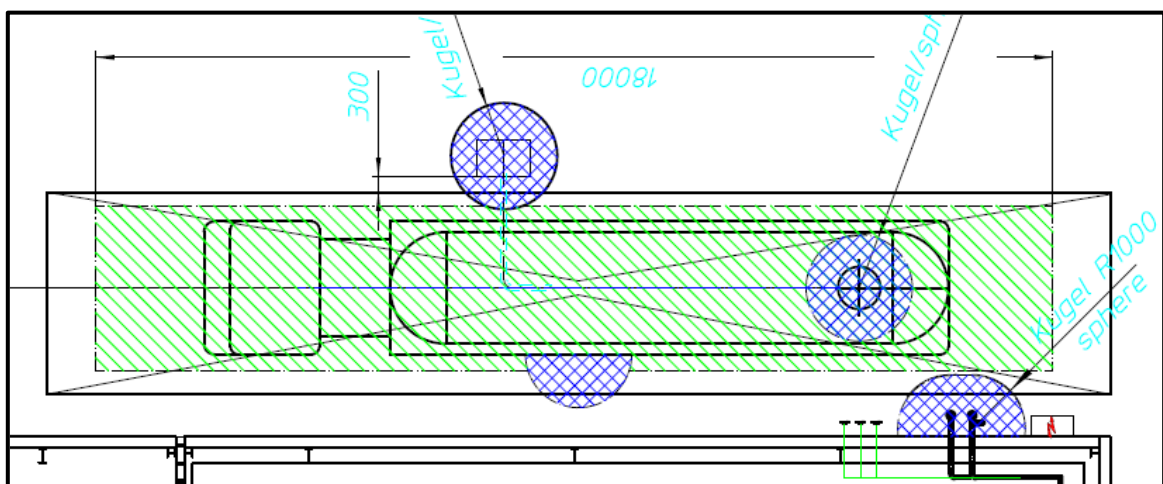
Schematisch weergave aansluiting KB-installatie DR Stage 1 ondergronds
